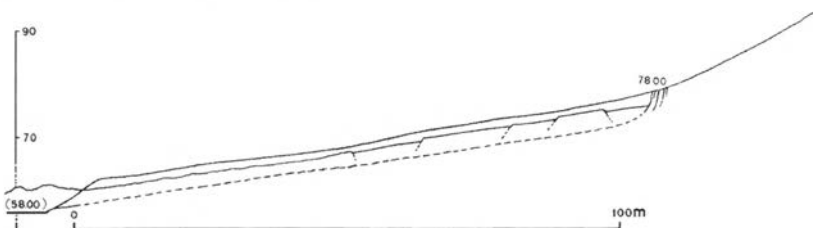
Perfil transversal do escorregamento sobre a Estrada Nacional 377-1.
